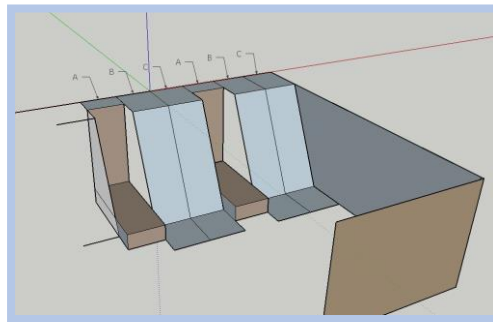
Posteriormente, empieza la excavación con los bataches A, debiéndose terminar completamente el muro de dicho tramo. Luego siguen los bataches B y C.
